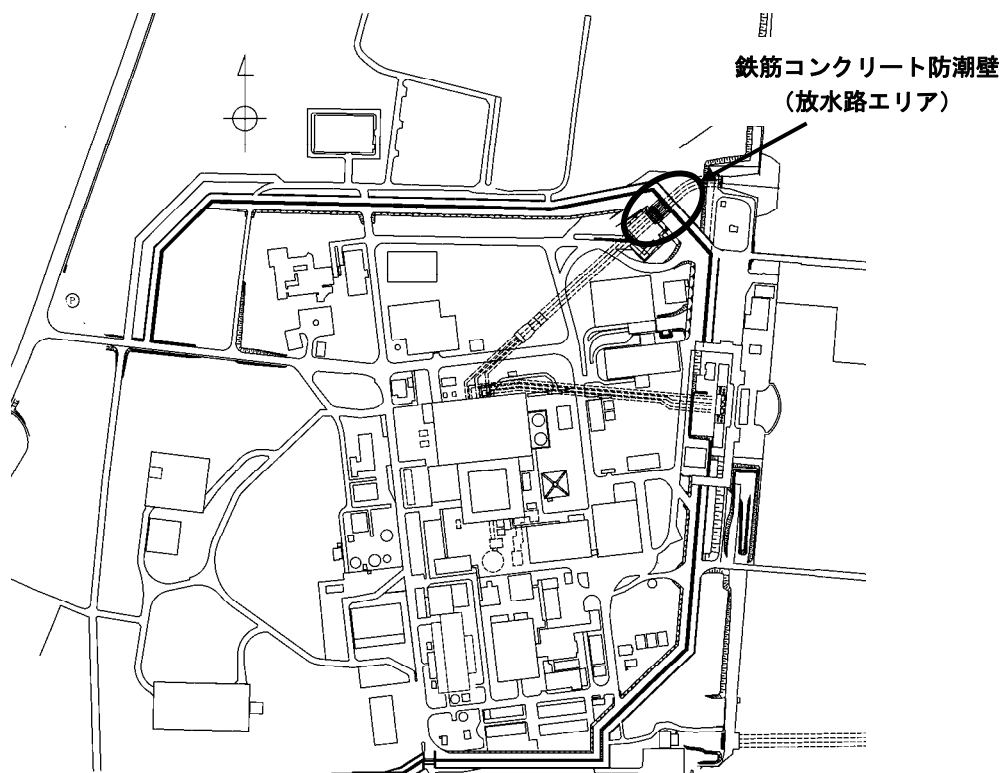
鉄筋コンクリート防潮壁（放水路エリア）の位置図
